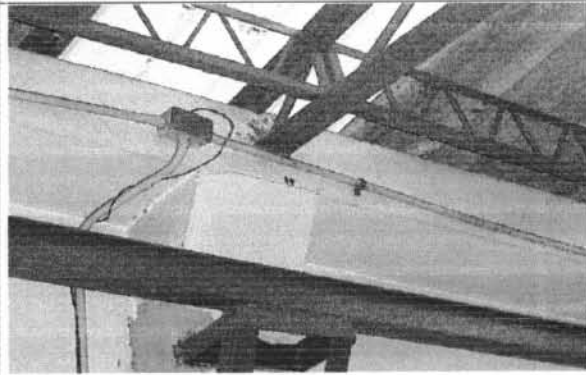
Vista interna de primer piso sin daño estructural aparente.
